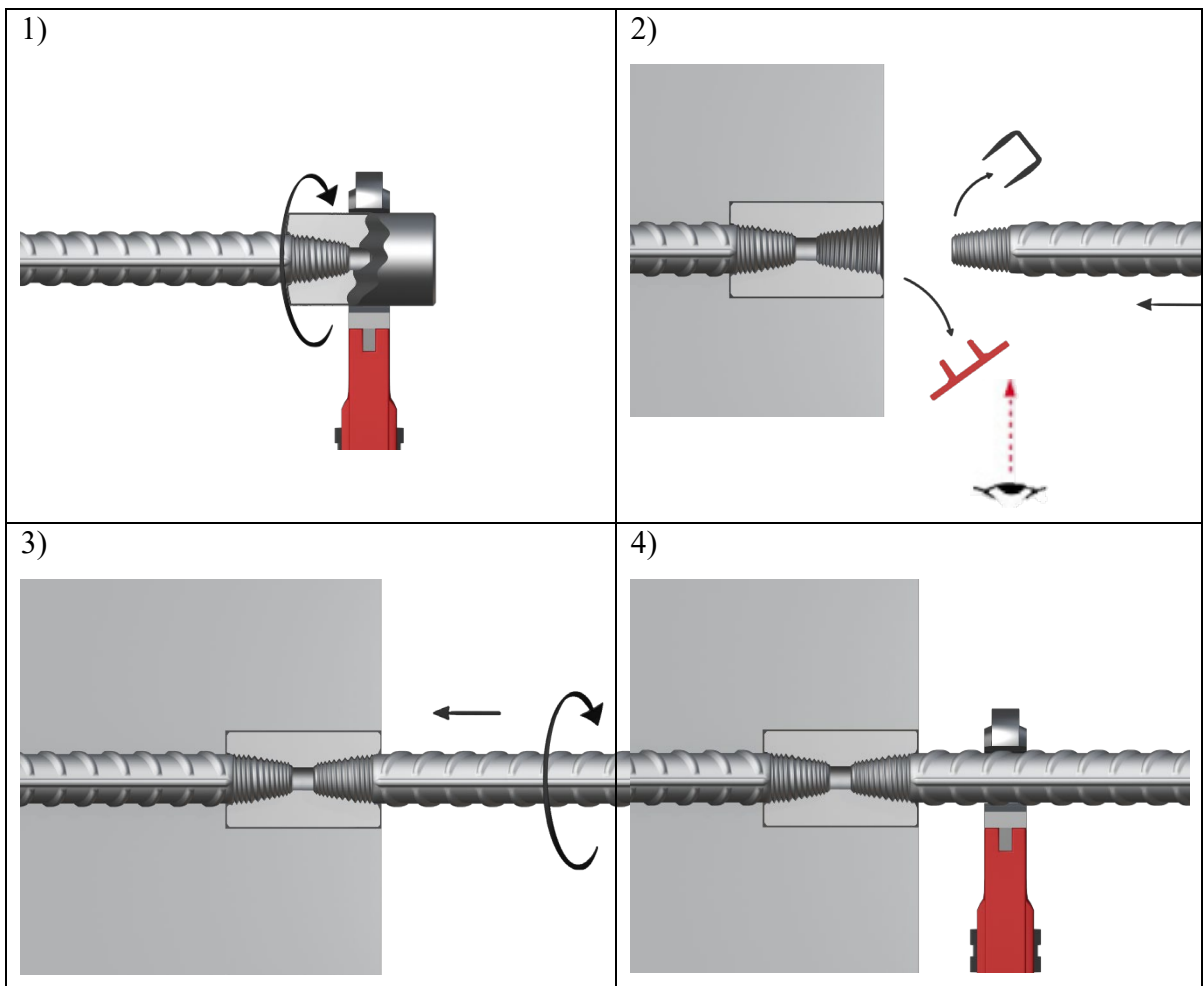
Сборка стандартных соединений с конической резьбой
